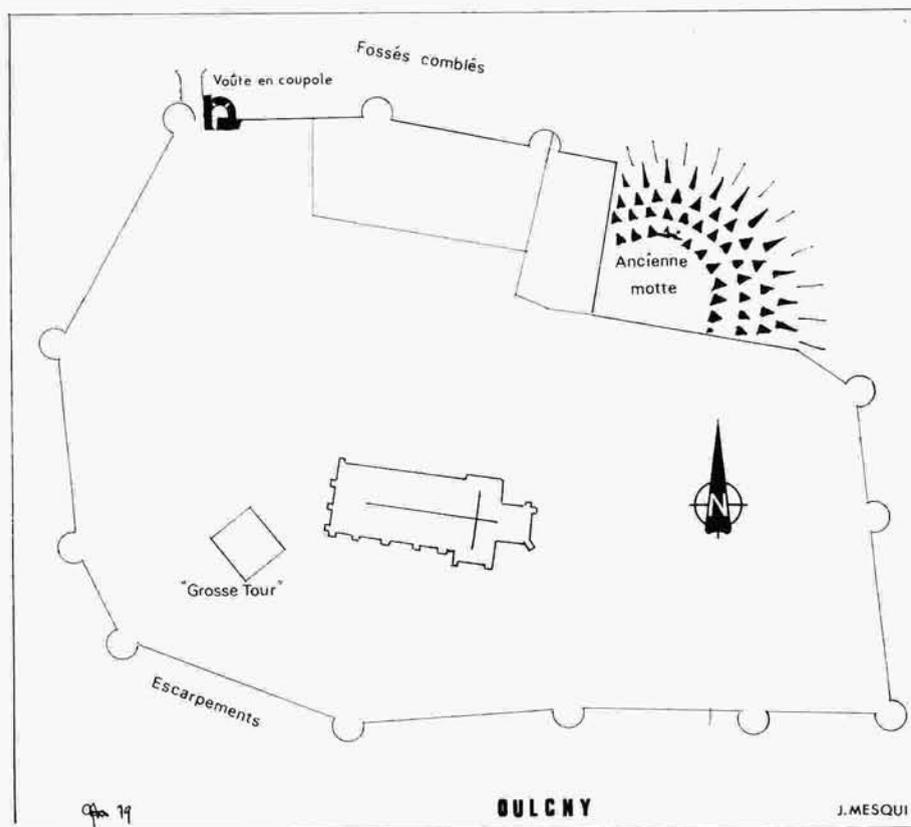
PLAN DU CHÂTEAU D'OULCHY, D'APRÈS UN PLAN DE 1756
